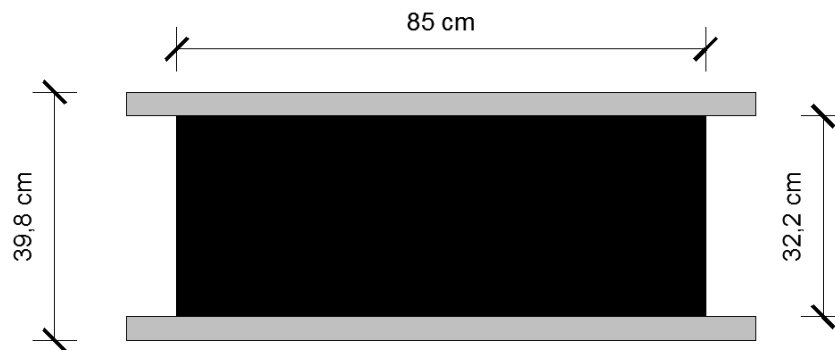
Dimensiones del aislador para el edificio de 10 pisos
